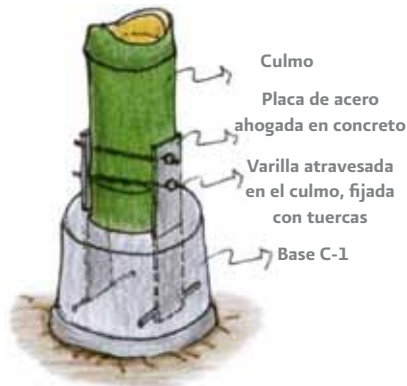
Anclaje de columnas, pies derechos y verticales a la cimentación con solera de acero y pernos.
